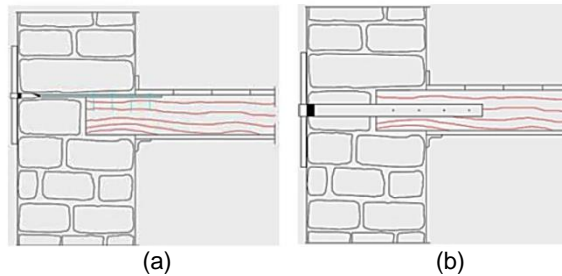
Representação esquemática de Reforço de ligação da viga à parede com barra de aço (adaptado de Baião, et al., 2012)
